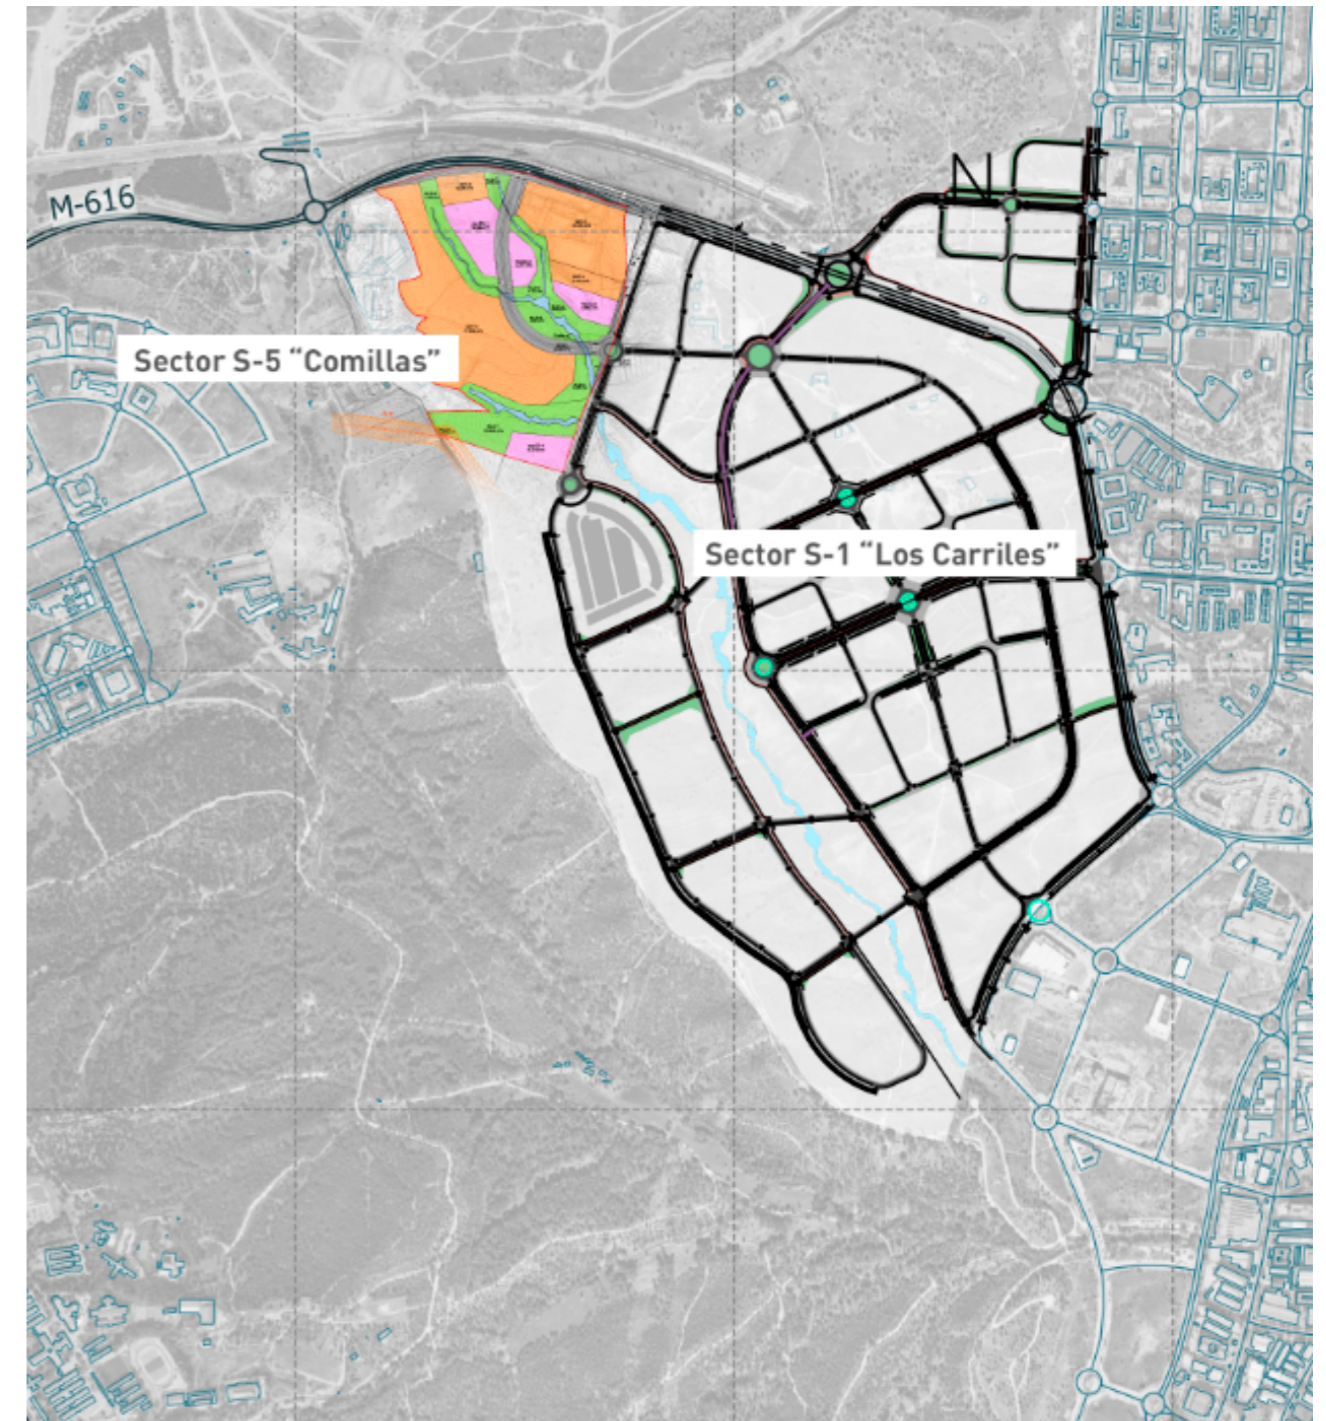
Planta de la red viaria futura, incluyendo los sectores S-1 y S-5.
